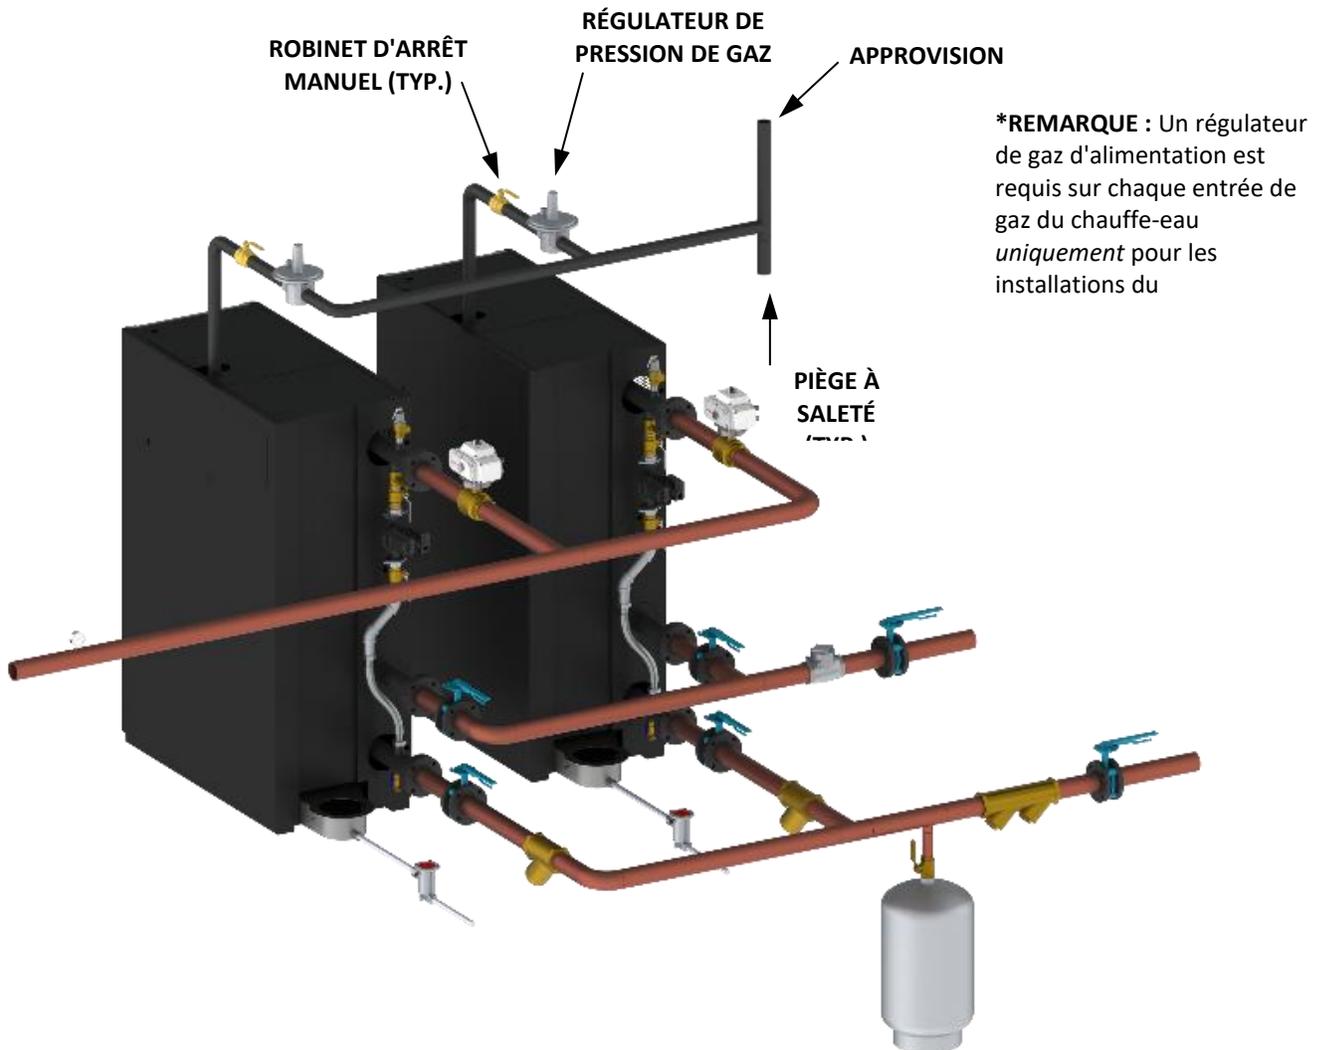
Construction typique d'un collecteur de chauffe-eau multiple
